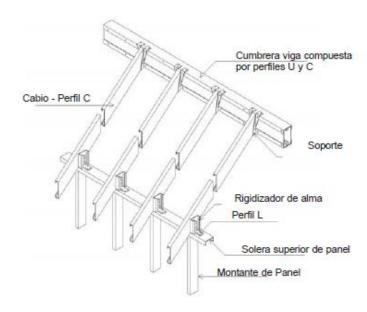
Cubierta estructurada con cabios. Fuente: (Alacero, 2014).
